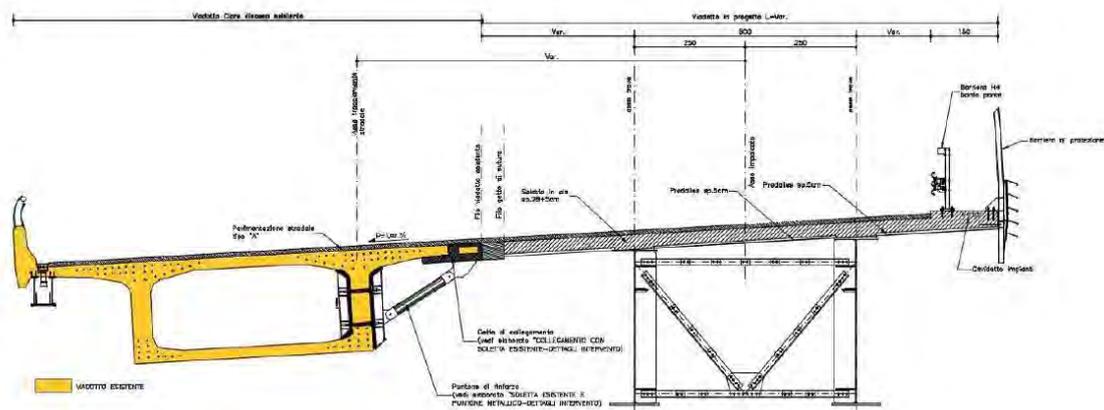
Sistema di collegamento nuovo viadotto-esistente.
